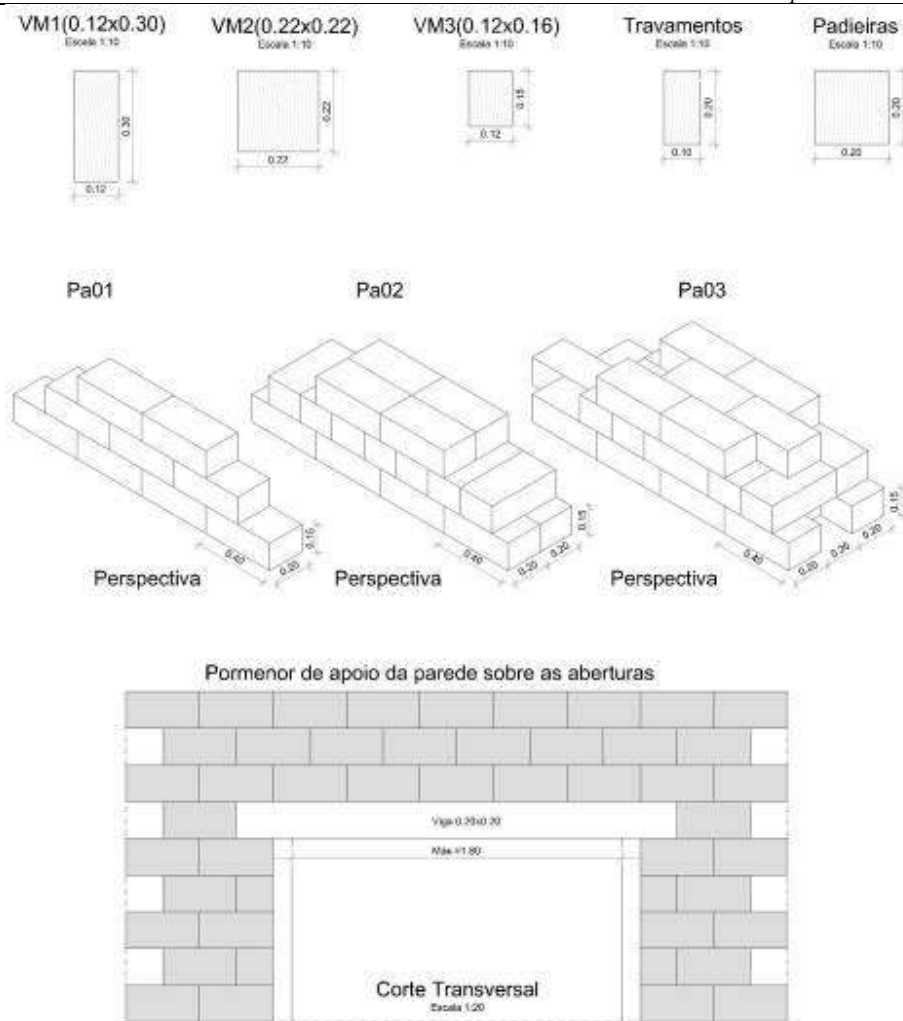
Pormenores estruturais e de construção para a solução sustentável
